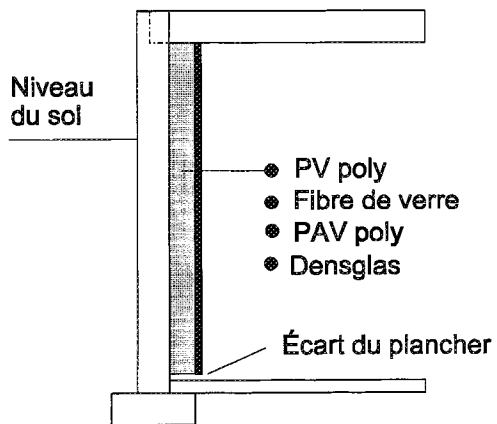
Panneau d'essai 3 – Mur à poteaux d'acier, écart du plancher, poly des deux côtés.
